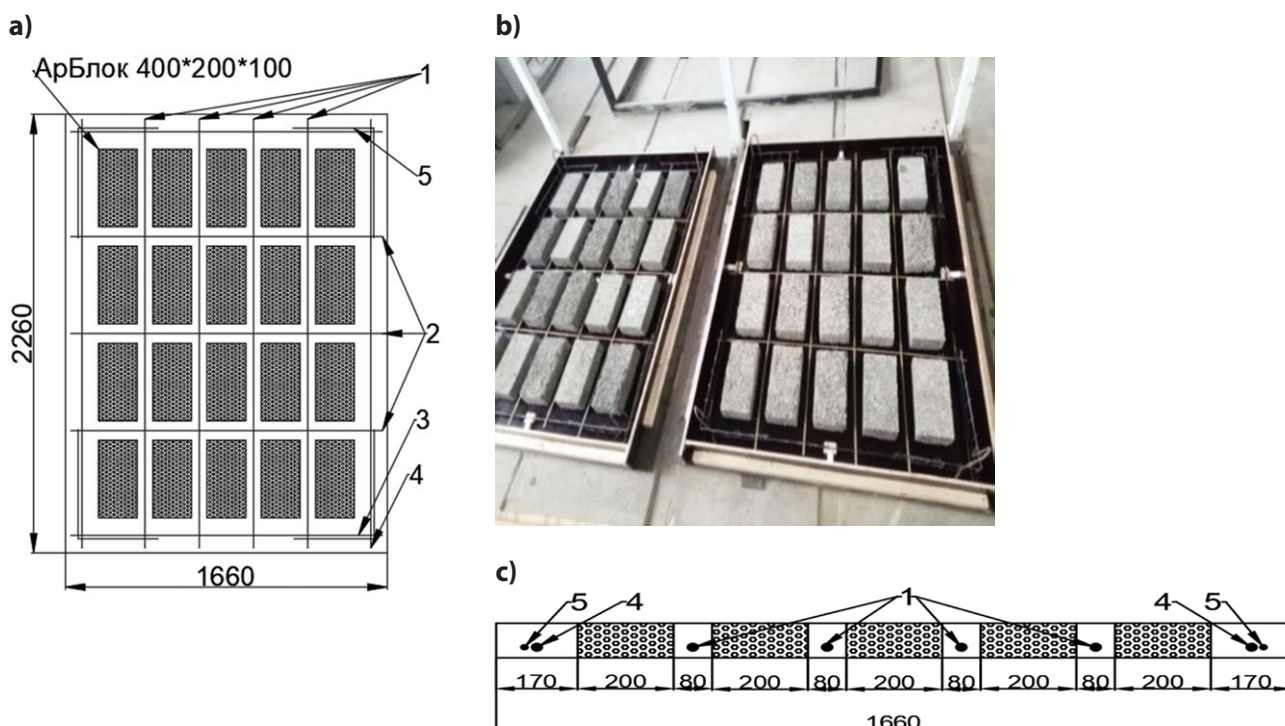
Конструкция опытных образцов: а, б) укладка блоков и арматур, в) разрез плиты:
